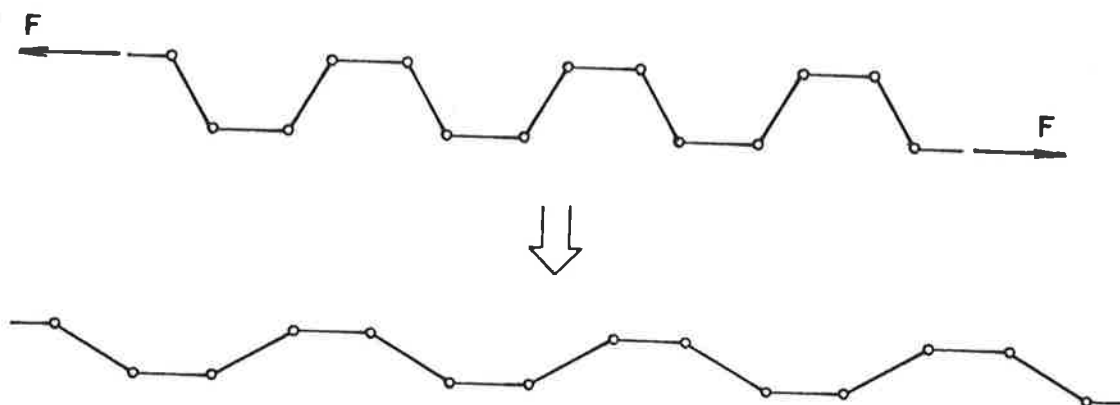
A consideração das lajes compostas como armadas na direção longitudinal às "estrias".
